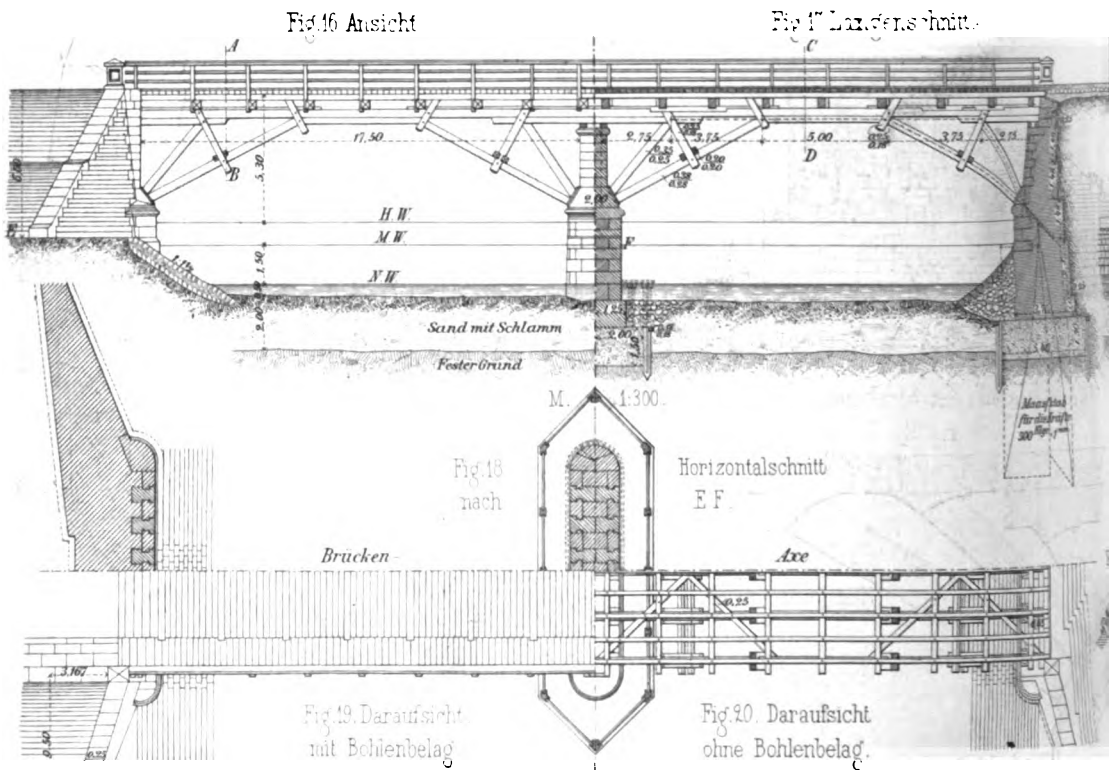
Straßenbrücke mit hölzernen Pfeilern.
